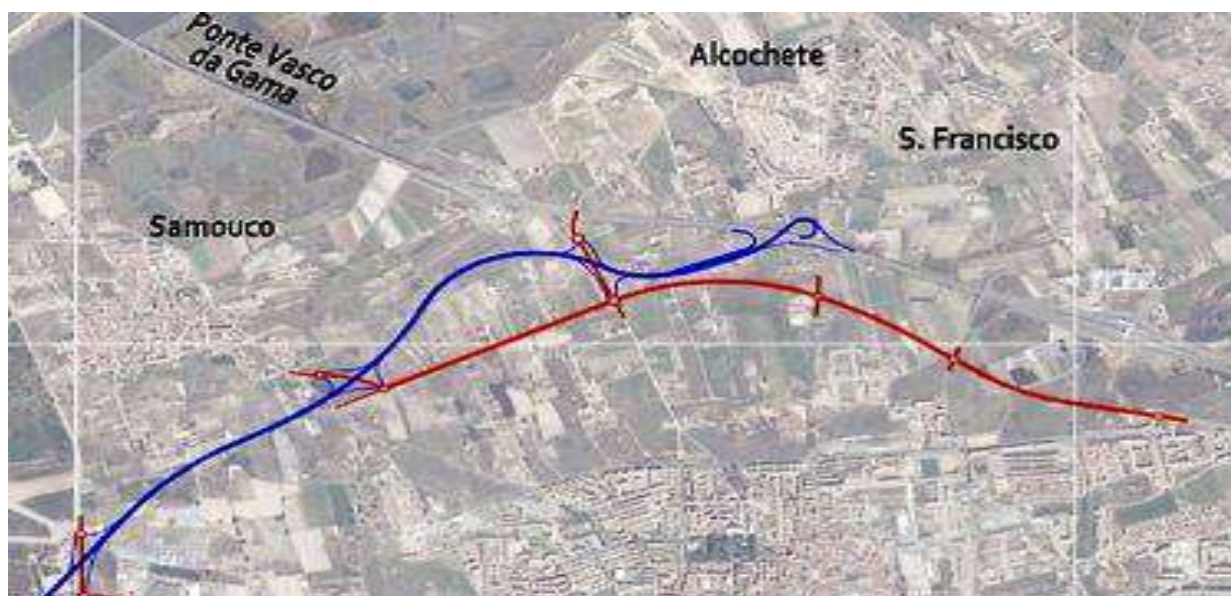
Lusoponte 2011 (Detalhe em Alcochete e no Montijo) – Circular do Arco Ribeirinho Sul - Traçado Preliminar de uma Ligação Barreiro – Montijo - A12
